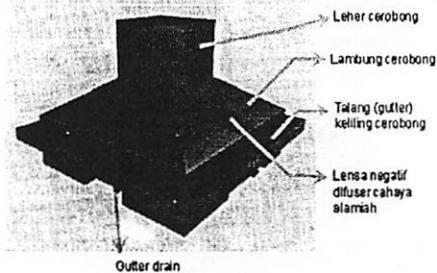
Potongan A-A ( detail potongan cerobong ) yang dapat dimanfaatkan 4 unit rumah )
